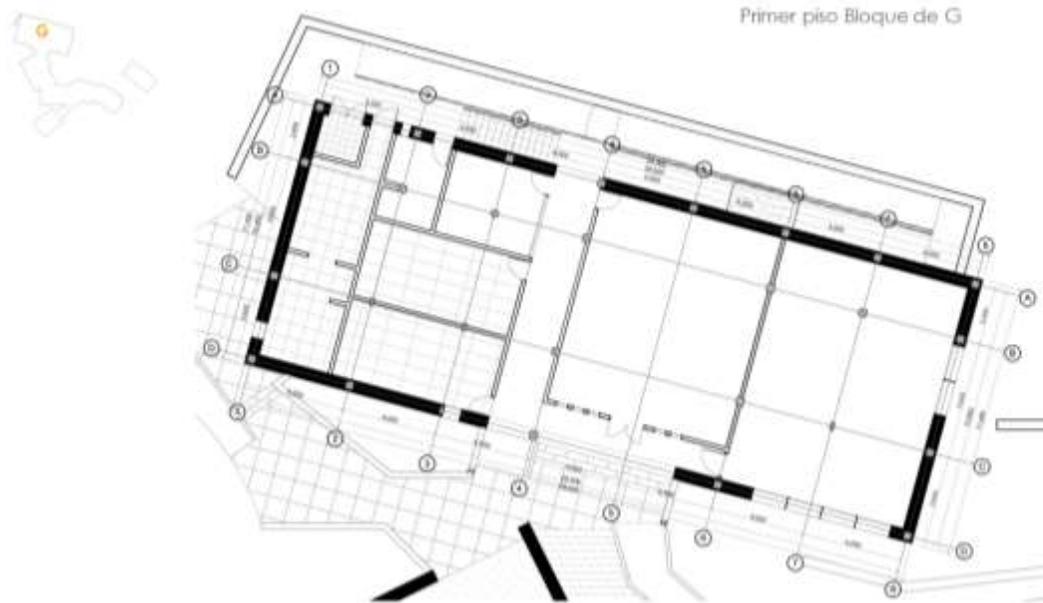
Sistema Estructural Primer Nivel Bloque G
